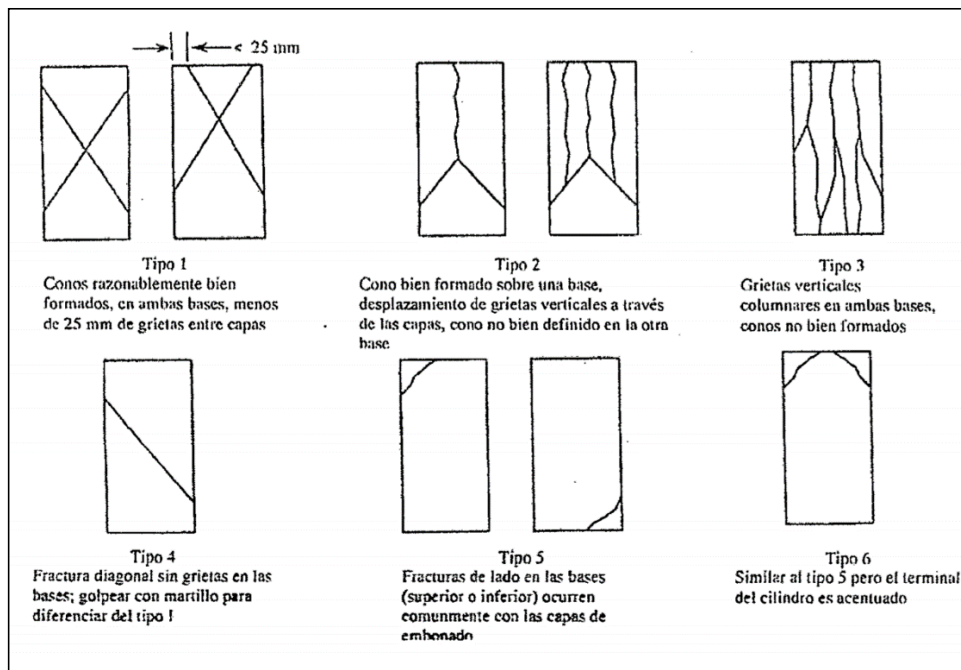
Fallas tipificadas en probetas de concreto, para el ensayo de resistencia a la compresión.
